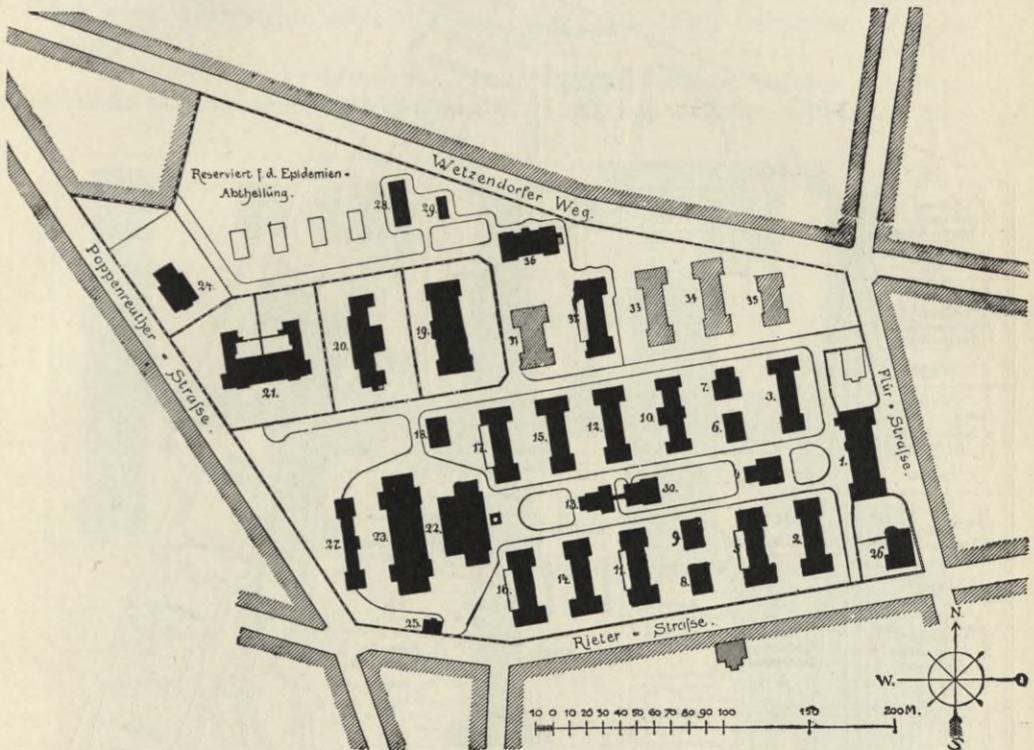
Allgemeines Krankenhaus in Nürnberg. Lageplan.
